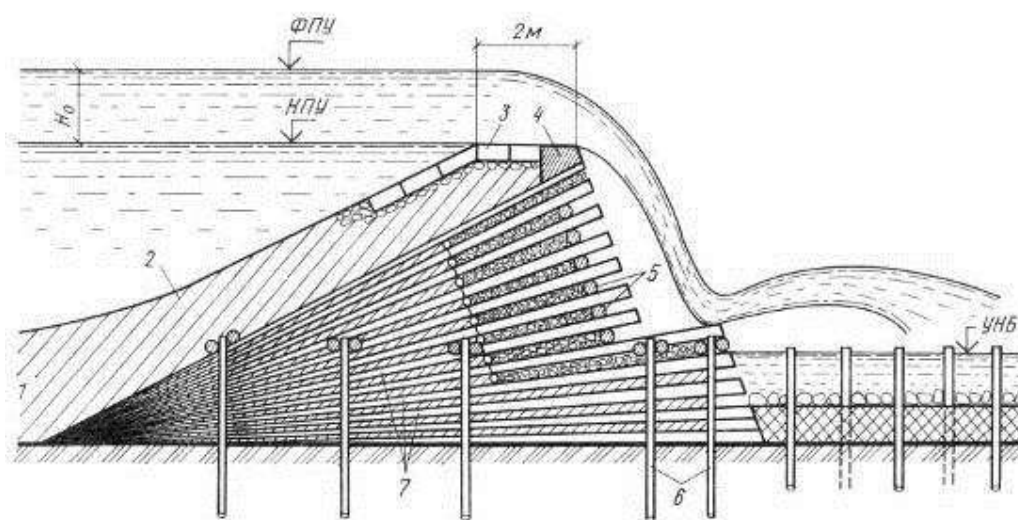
Сланевая плотина: 1 – понур; 2 – экран; 3 – бетонные плиты; 4 – шапочный брус; 5 – лежни из брёвен; 6 – сваи; 7 – сланевая кладка с загрузкой
